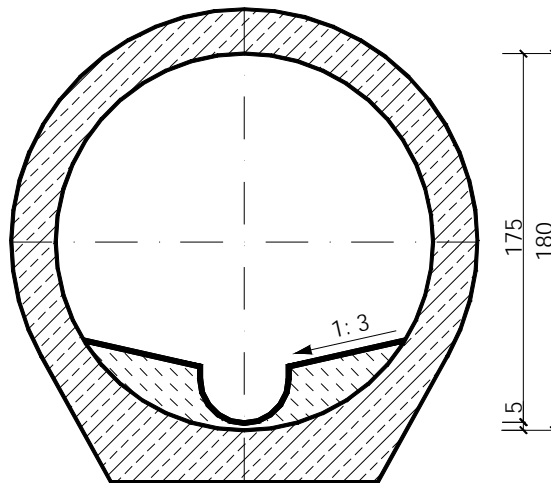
Typy rur betonowych i żelbetowych
